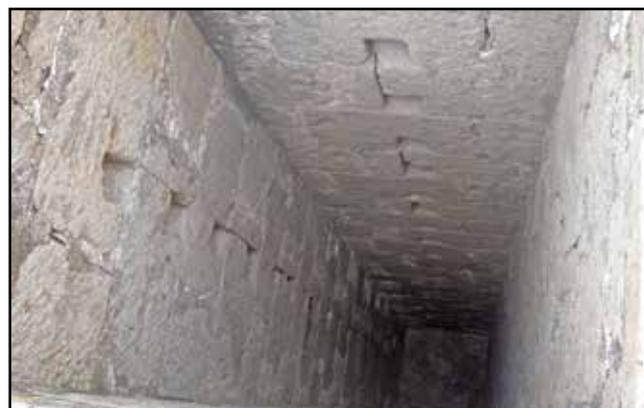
Pozo de la campana n° 1 de la Mina de Zamora (Telde), de planta cuadrangular y mechinales para bajar.
